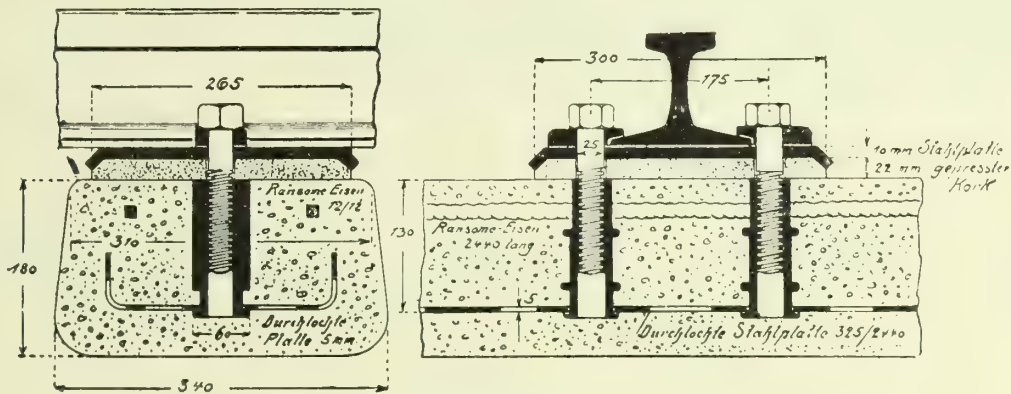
Eisenbeton-Schwelle der Gebr. Beezer
